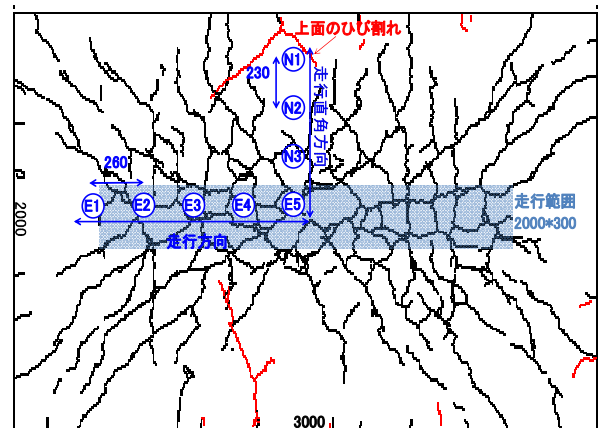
輪荷重走行試験終了時のひび割れ状況
